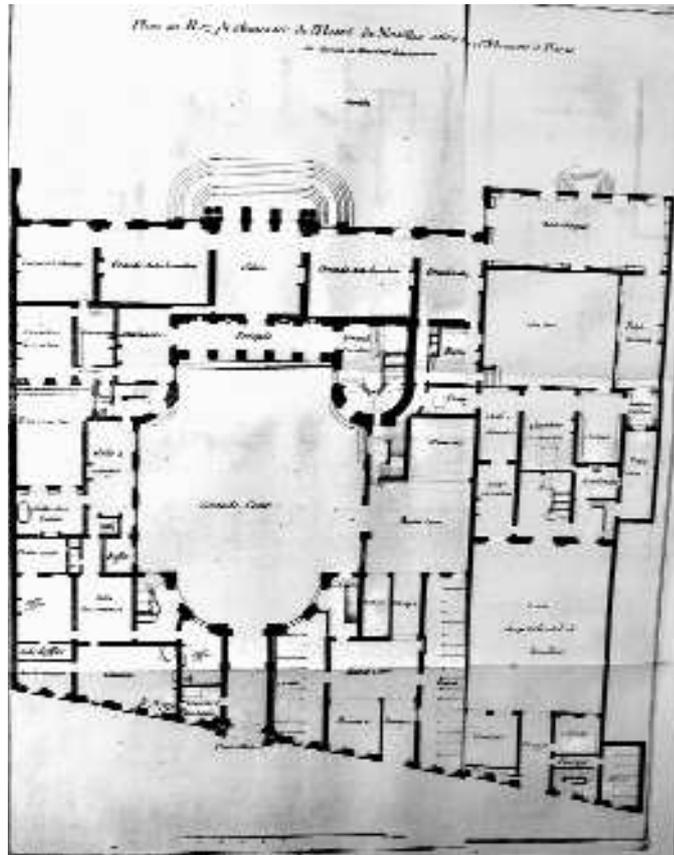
Lassurance, Hôtel Noailles, Grundriß
